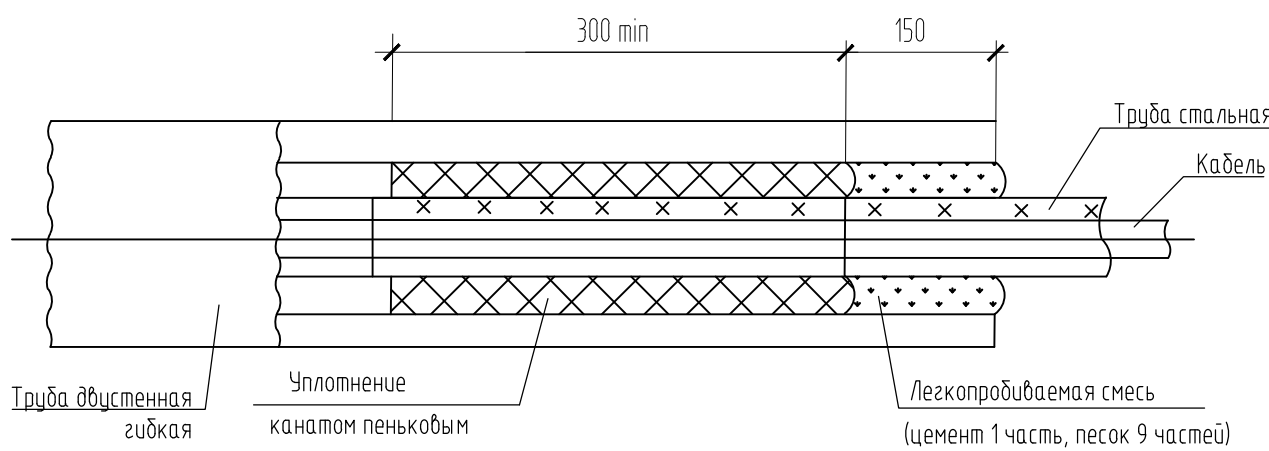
Заделка концов водогазопроводных труб после прокладки кабеля
